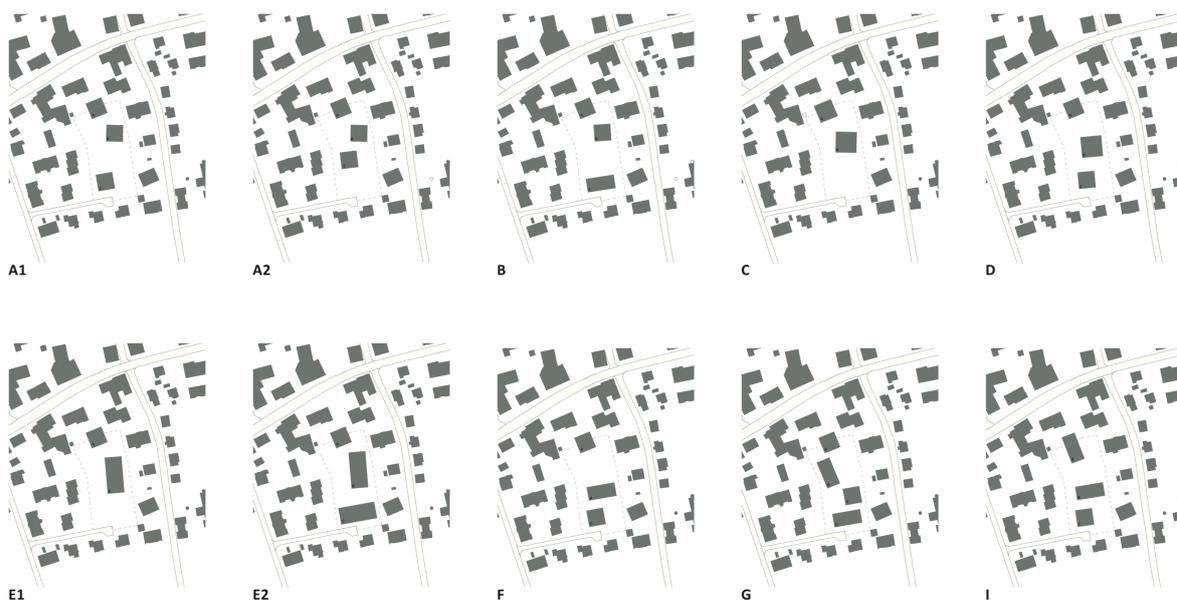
Übersicht der Grundrisse der zehn Bebauungsvarianten (Stand 2. Workshop).
